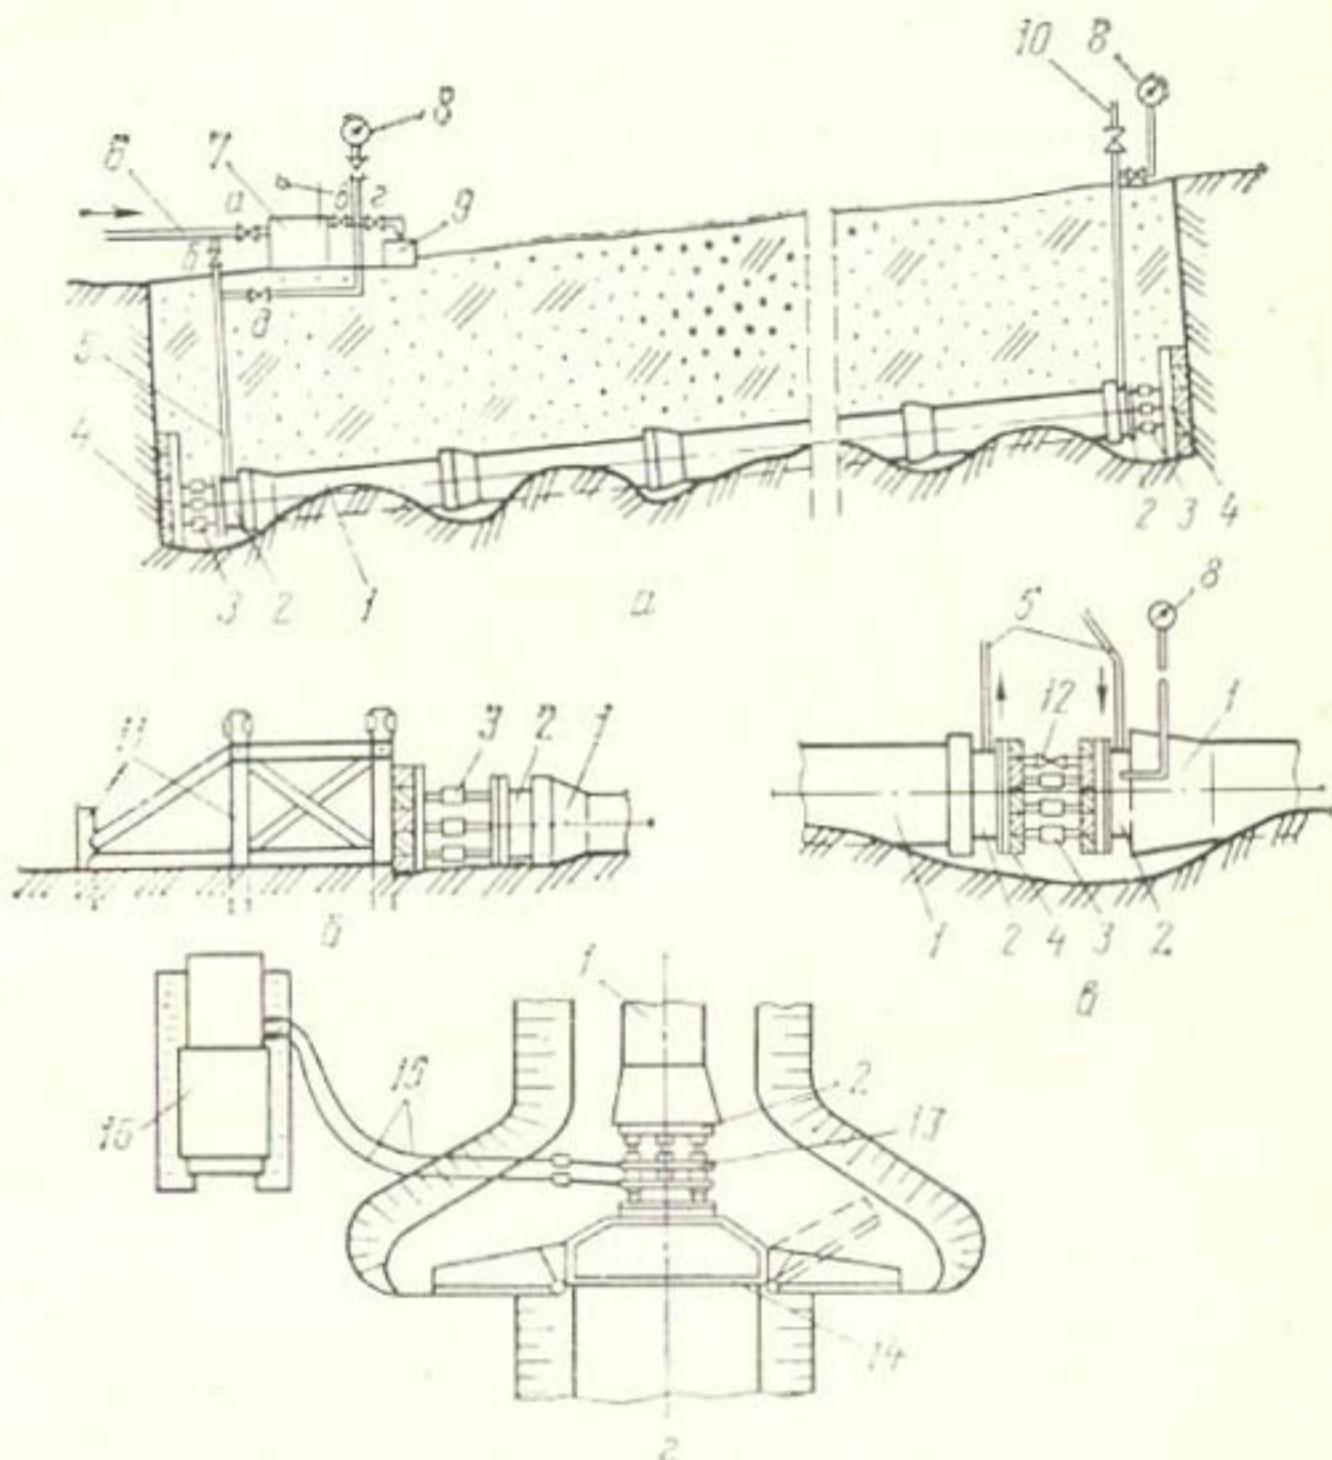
Схема гидравлического испытания участка трубопровода:
